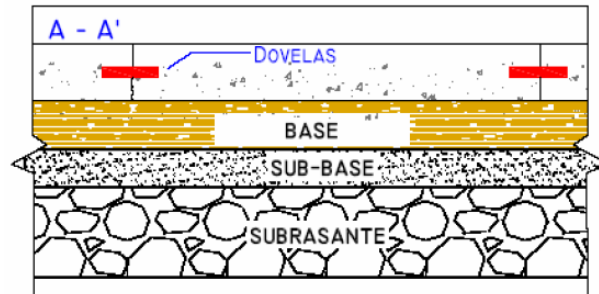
Vista en perfil de una losa de hormigón simple con pasadores (INVIAS, 2006)
